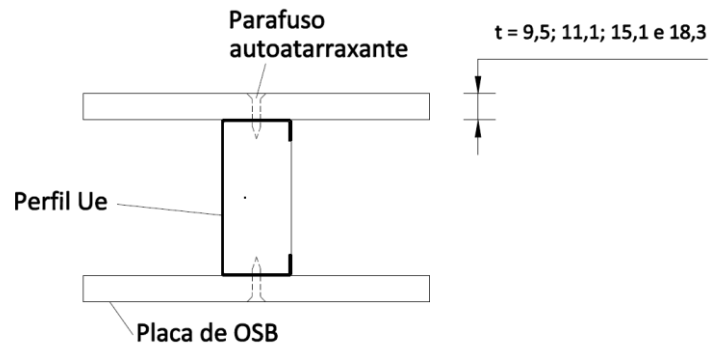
Vista em planta do Modelo 1 para o ensaio de "push-out".
